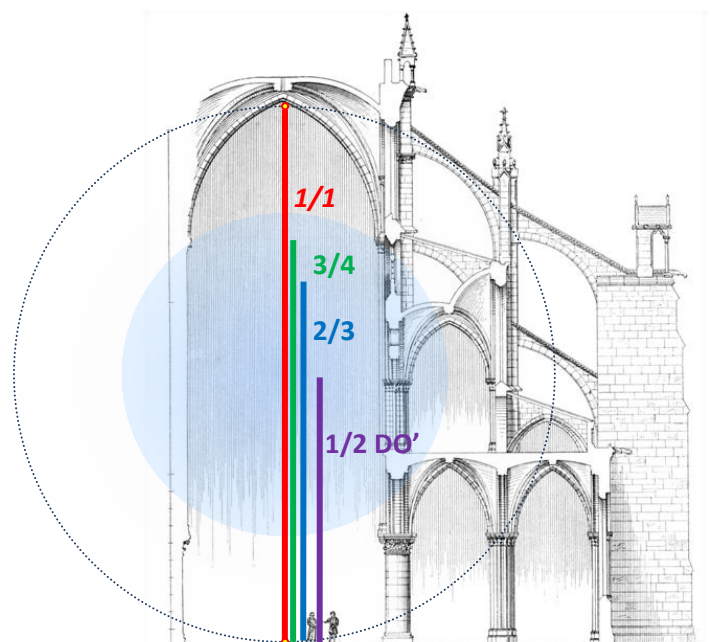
SCHEMA ELEVAZIONE IN FUNZIONE TRIANGOLARE NOTRE-DAME
